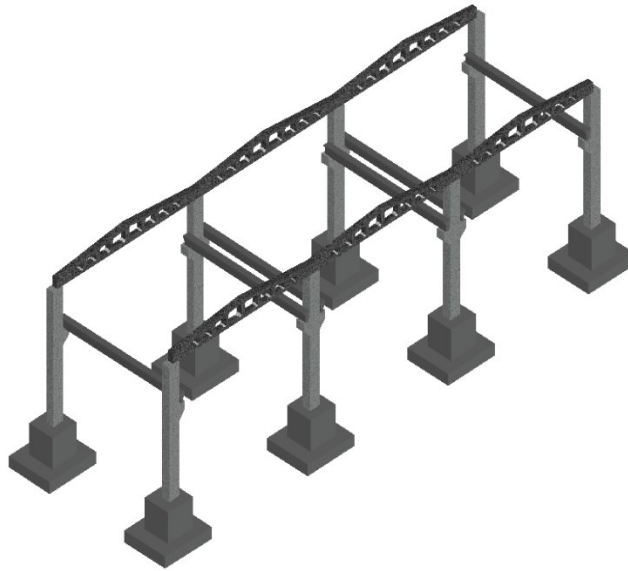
Фрагмент каркаса с подкрановыми балками
